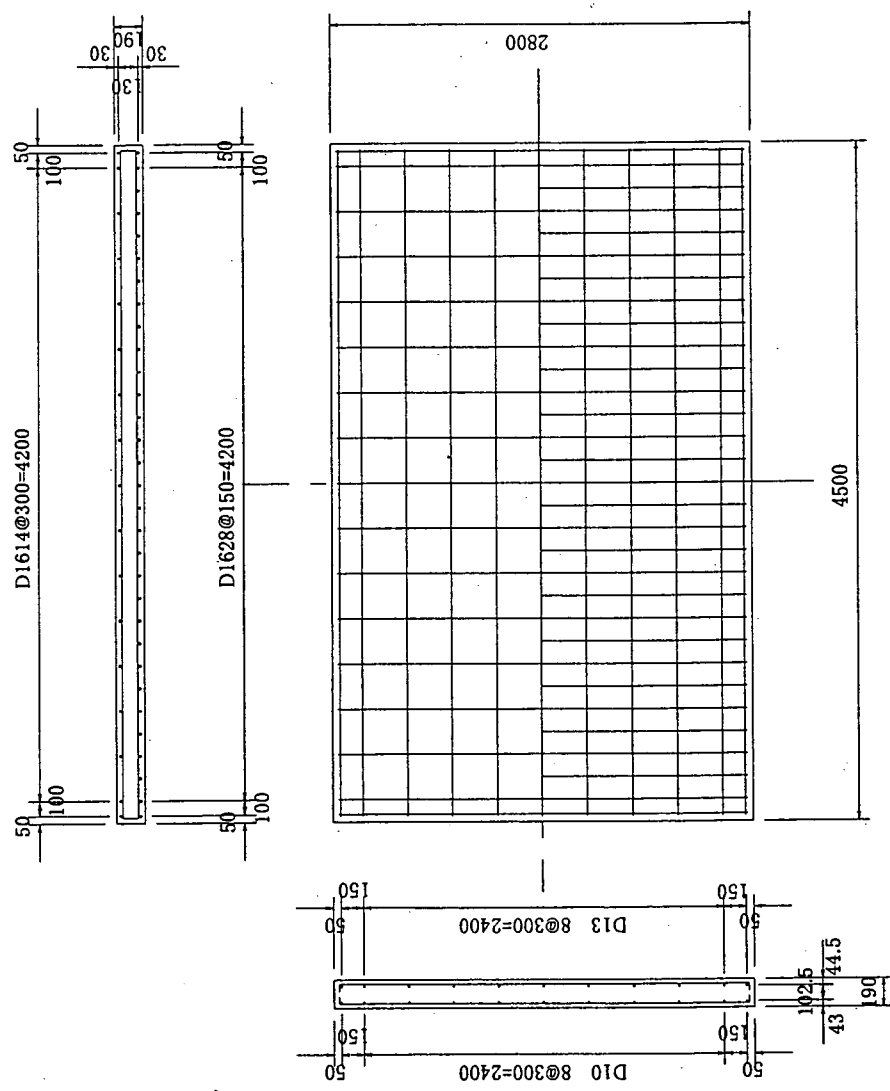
RC39-1,3~9供試体の形状・寸法 (単位:mm)
